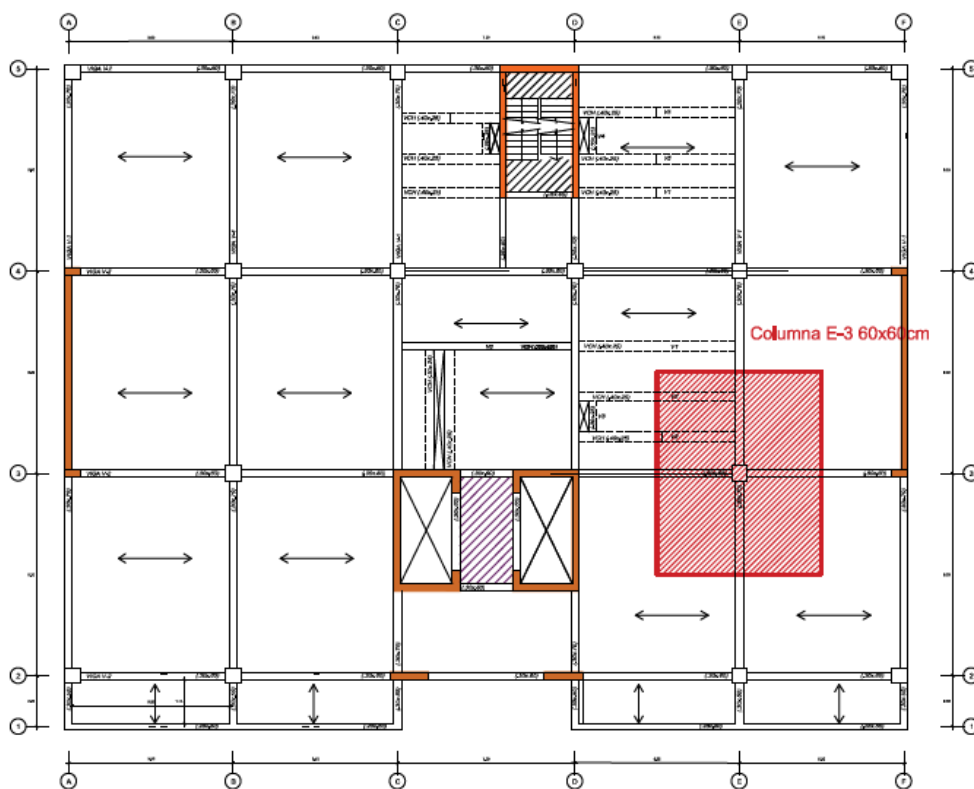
Ubicación de columna en planta y su respectiva área de tributaria
